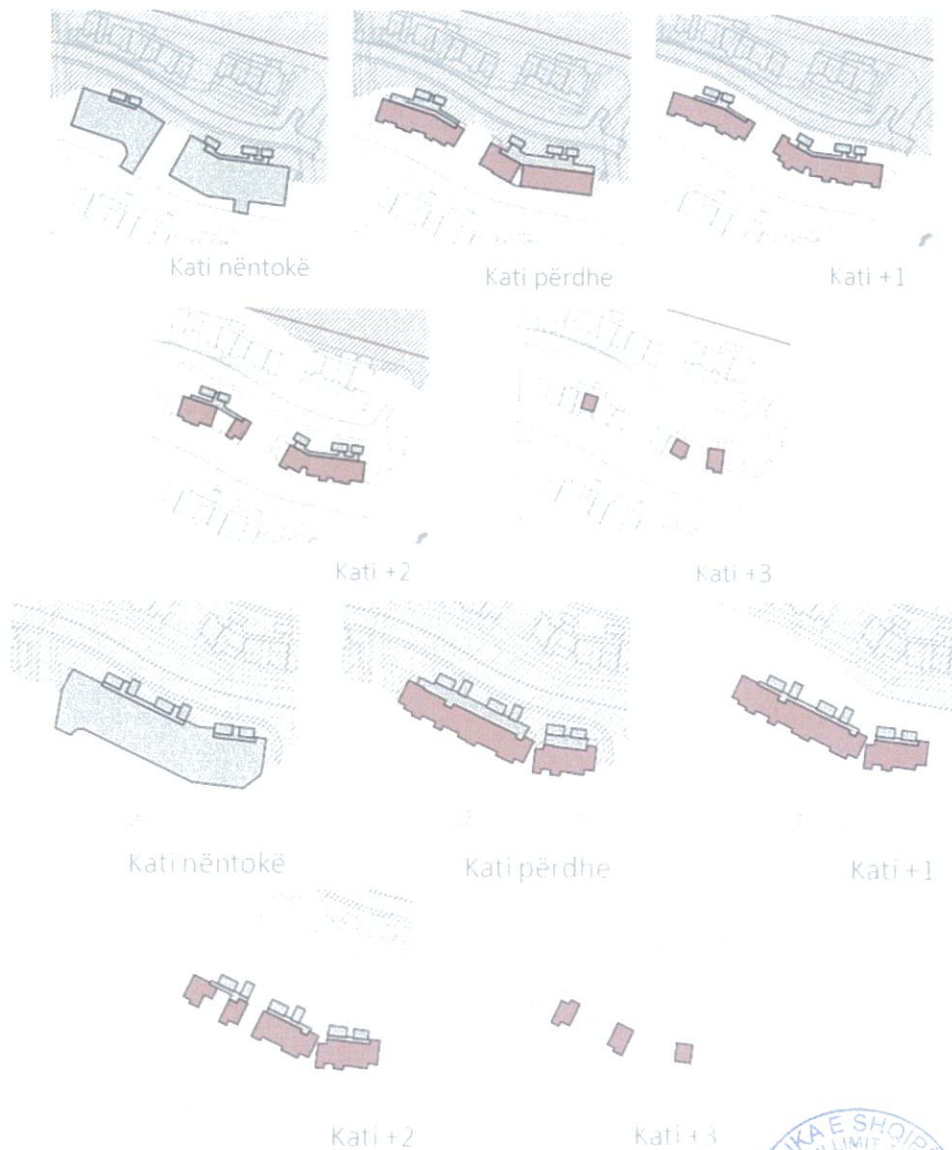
ZONA E1- Zonë me përdorim apartamente
